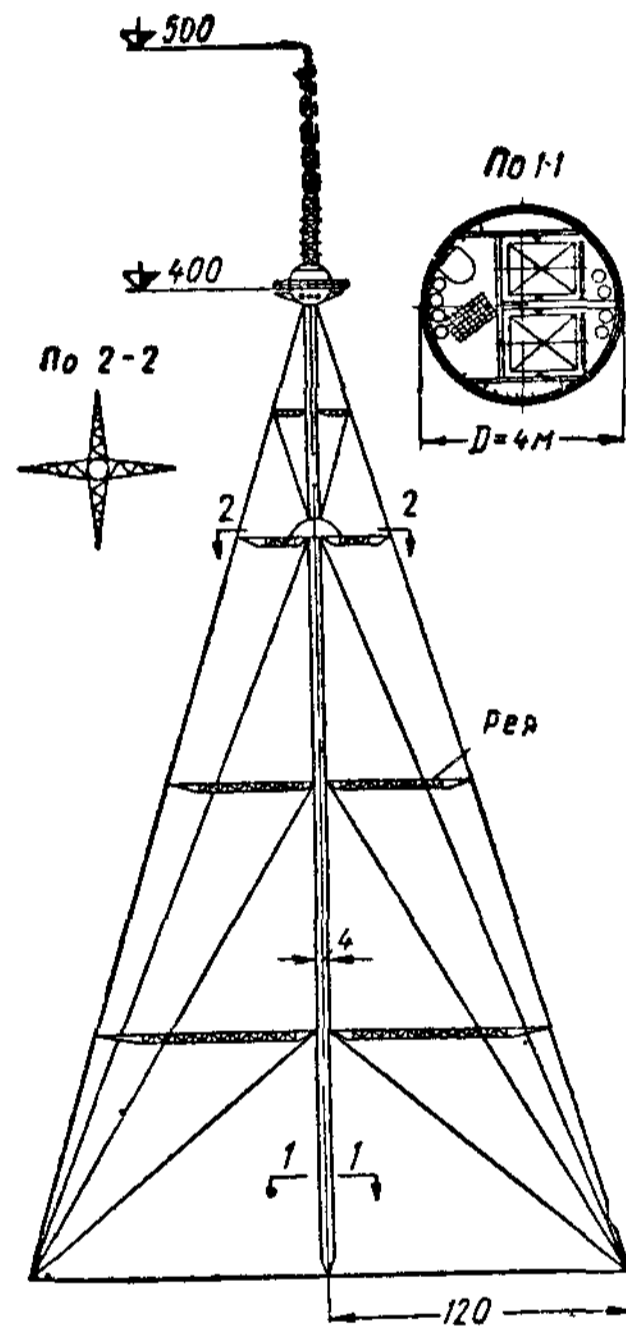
Телевизионная мачта высотой 500 м с железобетонным стволом, раскрепленным ребрами и крутонаправленными оттяжками (ГПИ Проектстальконструкция)
